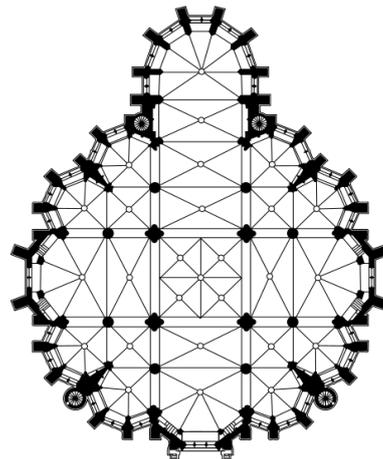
Trier, Liebfrauenkirche, Grundriss, 1242
